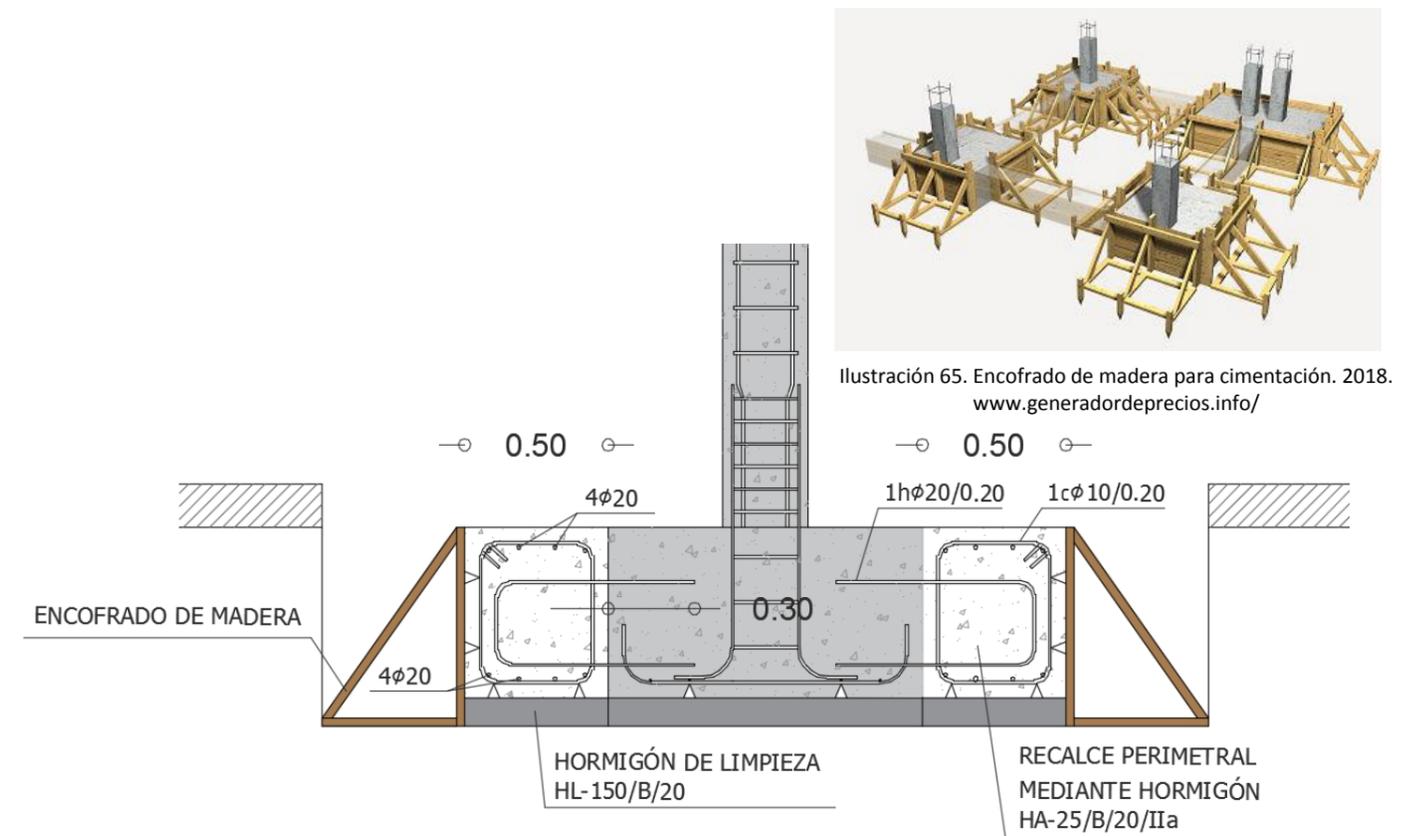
Sección de la zapata reforzada. 2018. Elaboración propia
